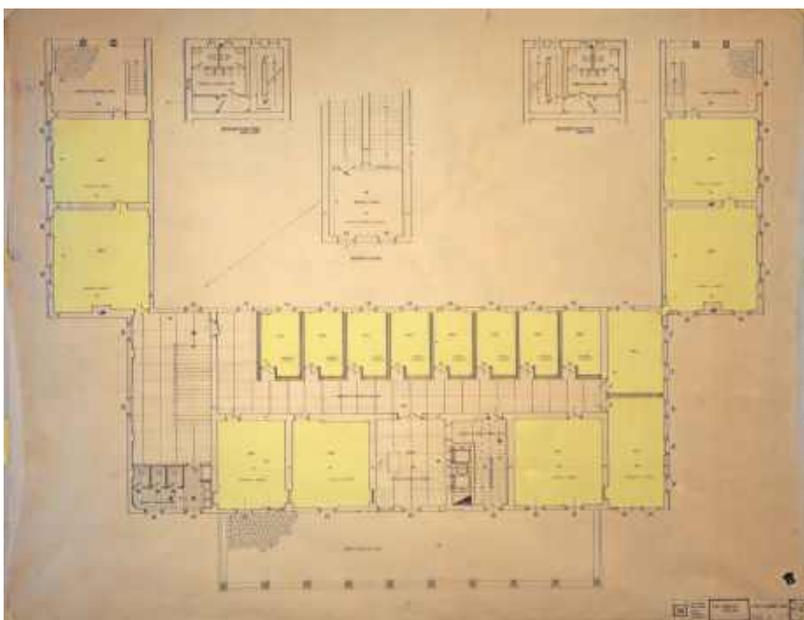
Pianta piano secondo (rielaborazione, giallo-aule), tavola di progetto su lucido
